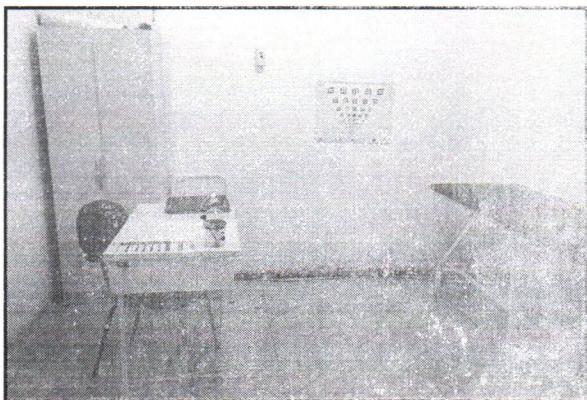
Vista de Sala de Enfermagem, com destaque a umidade em paredes
